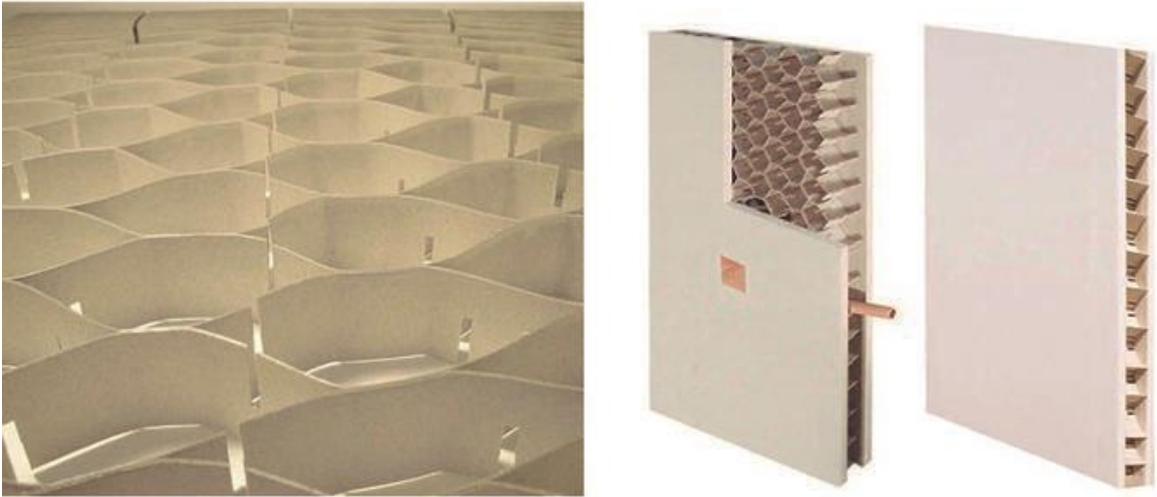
Detalle de Tabique Panelgyp – Fuente ArchDayly
